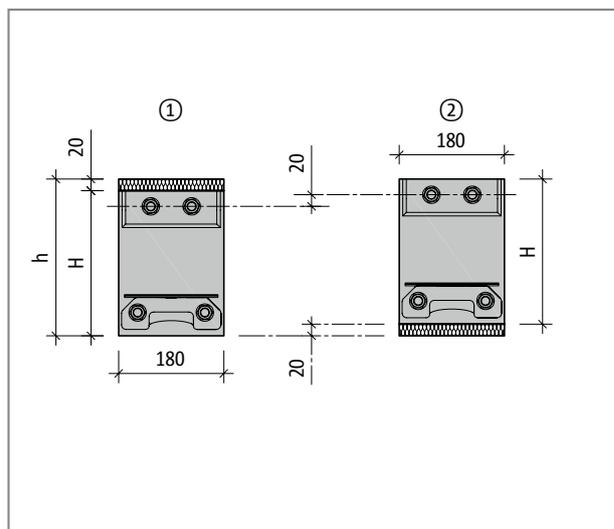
Schöck Isokorb® T type SK : Disposition avec décalage de hauteur
